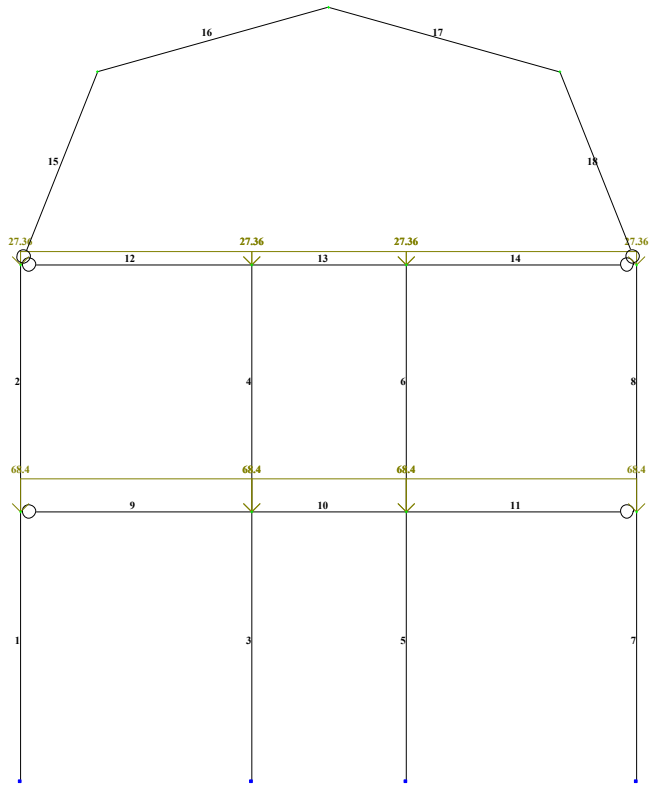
Расчетная схема от временной нагрузки на междуэтажные перекрытия(1 вариант).
